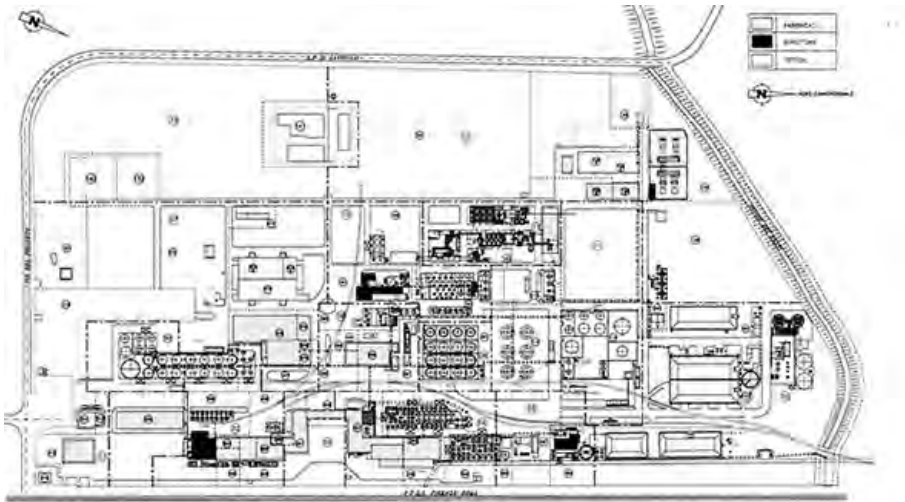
Planimetria stabilimento oggi (Archivio Polynt SGV)
